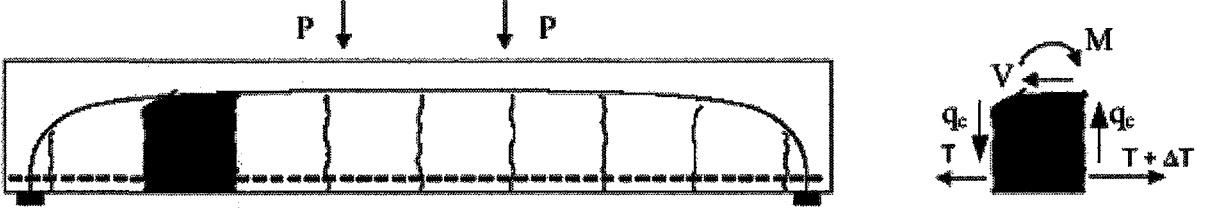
Kiriş etkisi altında kesme kırılması (Park ve Paulay, 1975)
